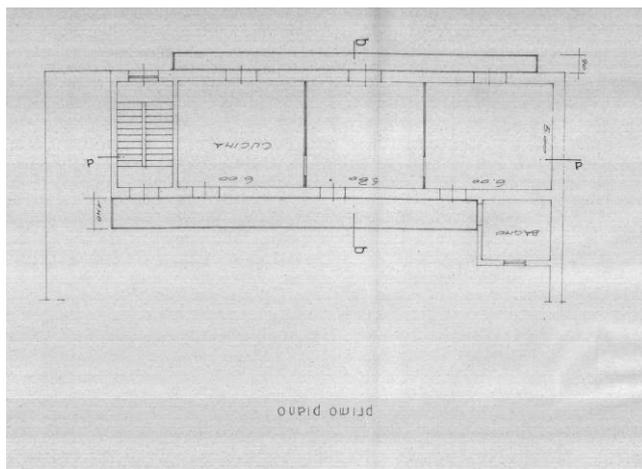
planimetria urbanistica appartamento al primo piano secondo la L.E. n.4545/1977 del 21/04/1977
